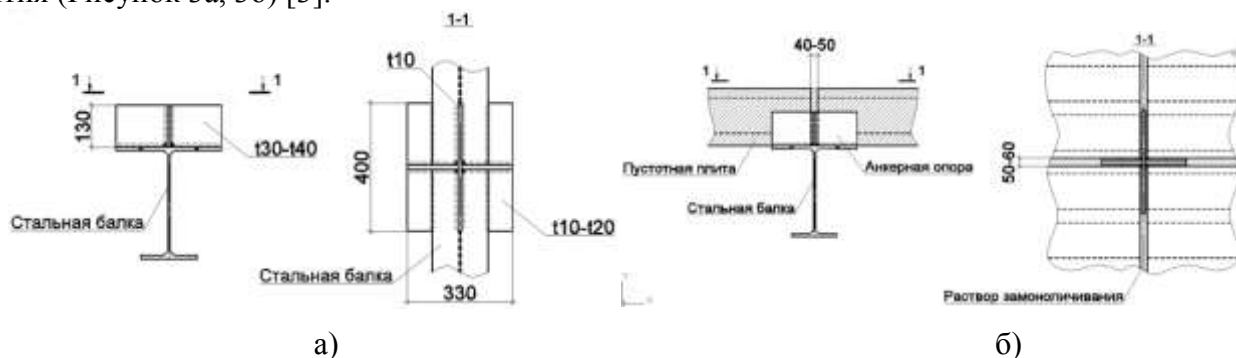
Устройство жестких упоров сталежелезобетонного перекрытия
